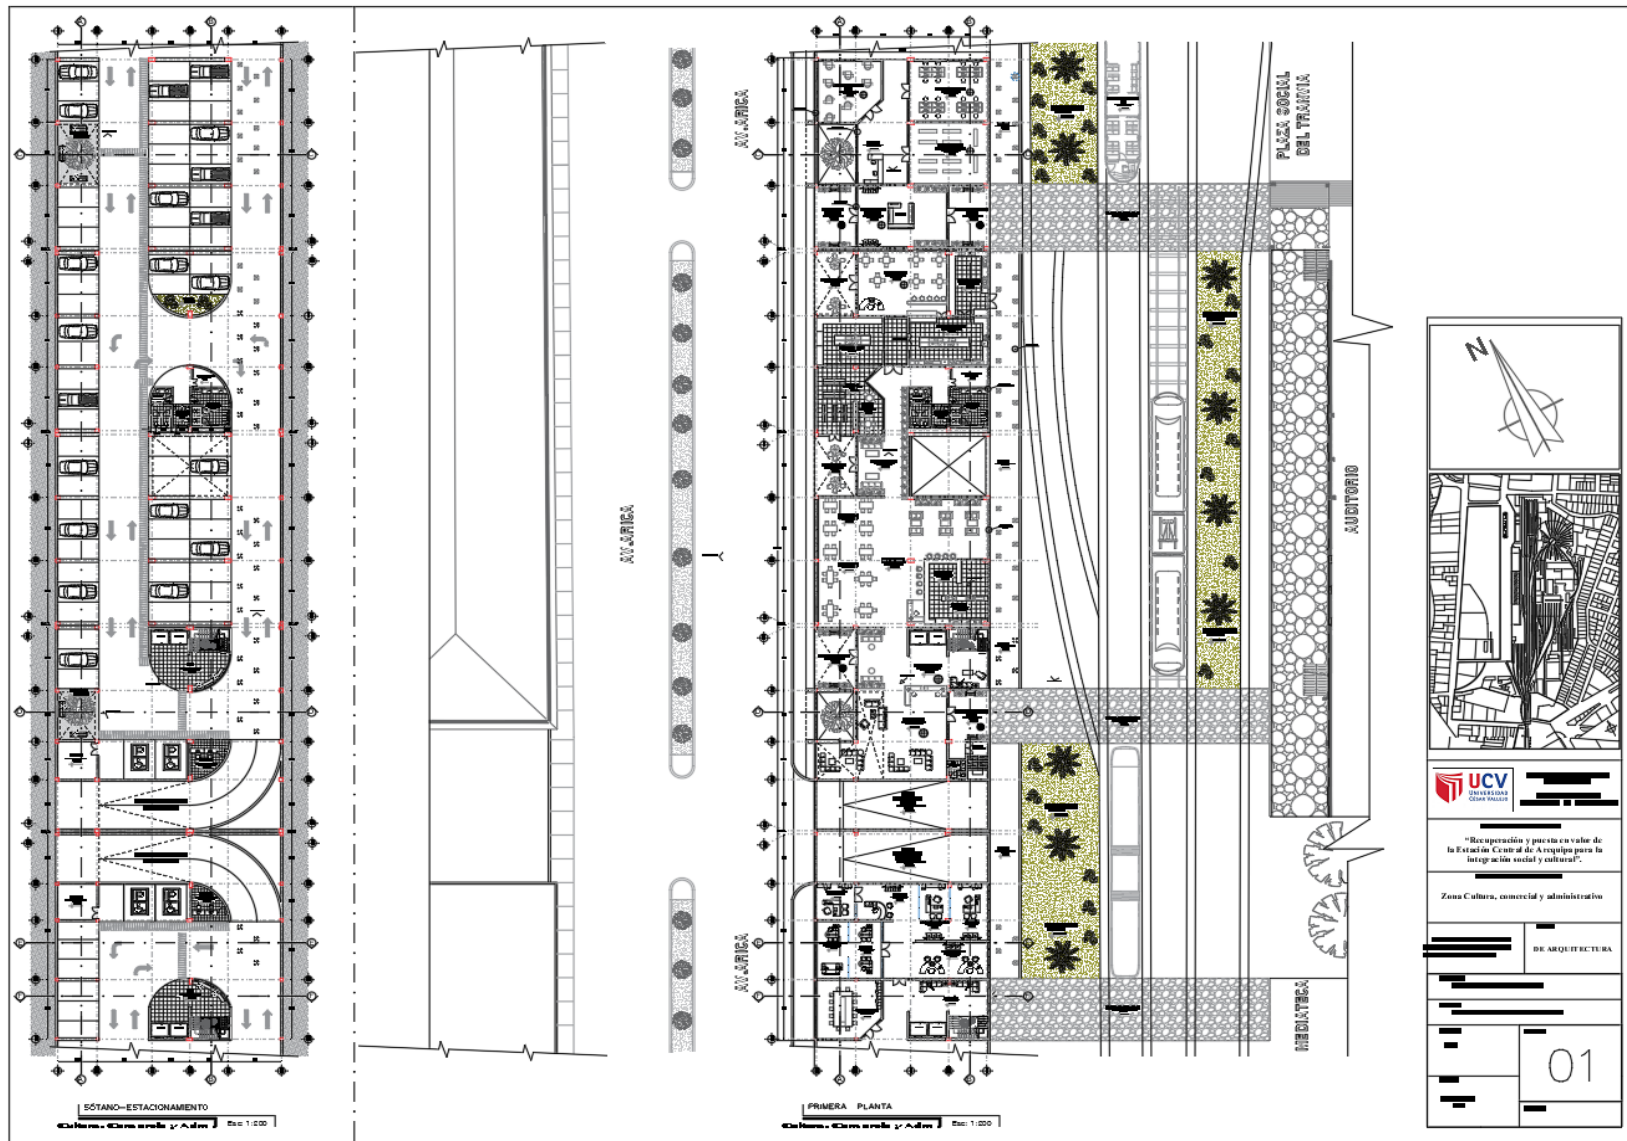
Plano de distribución arquitectónica del Sector- SÓTANO Y PRIMER NIVEL
